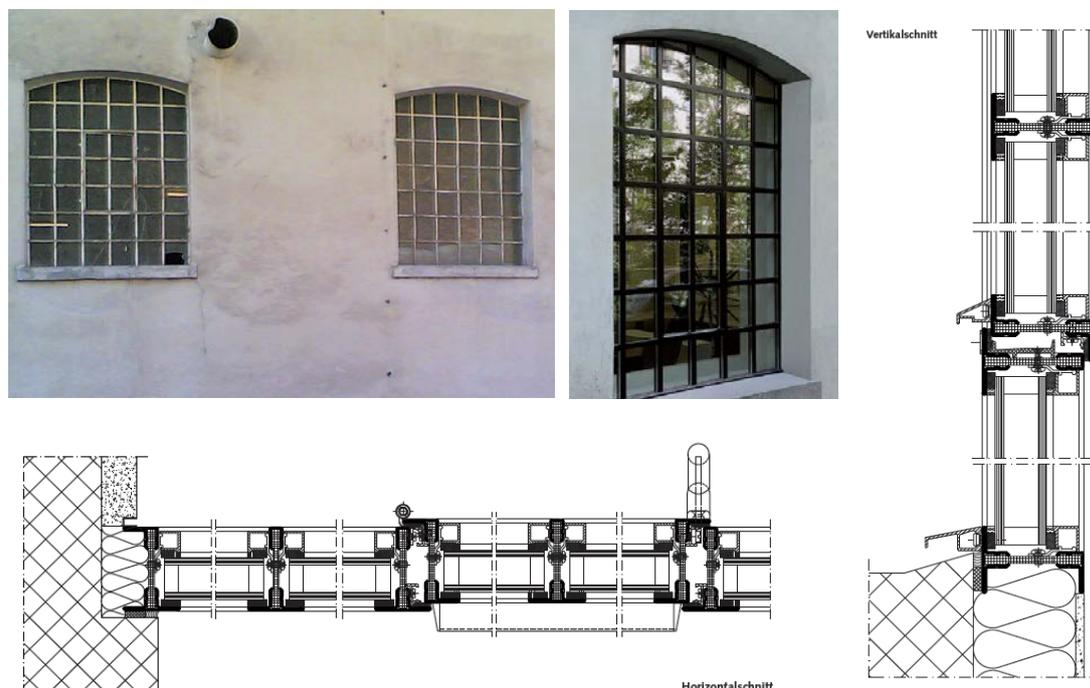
Zeitgemäße Sanierung eines Industriedenkmals durch fachgerechten Nachbau von Metallfenstern mit Sprossen und gutem Wärmeschutz
